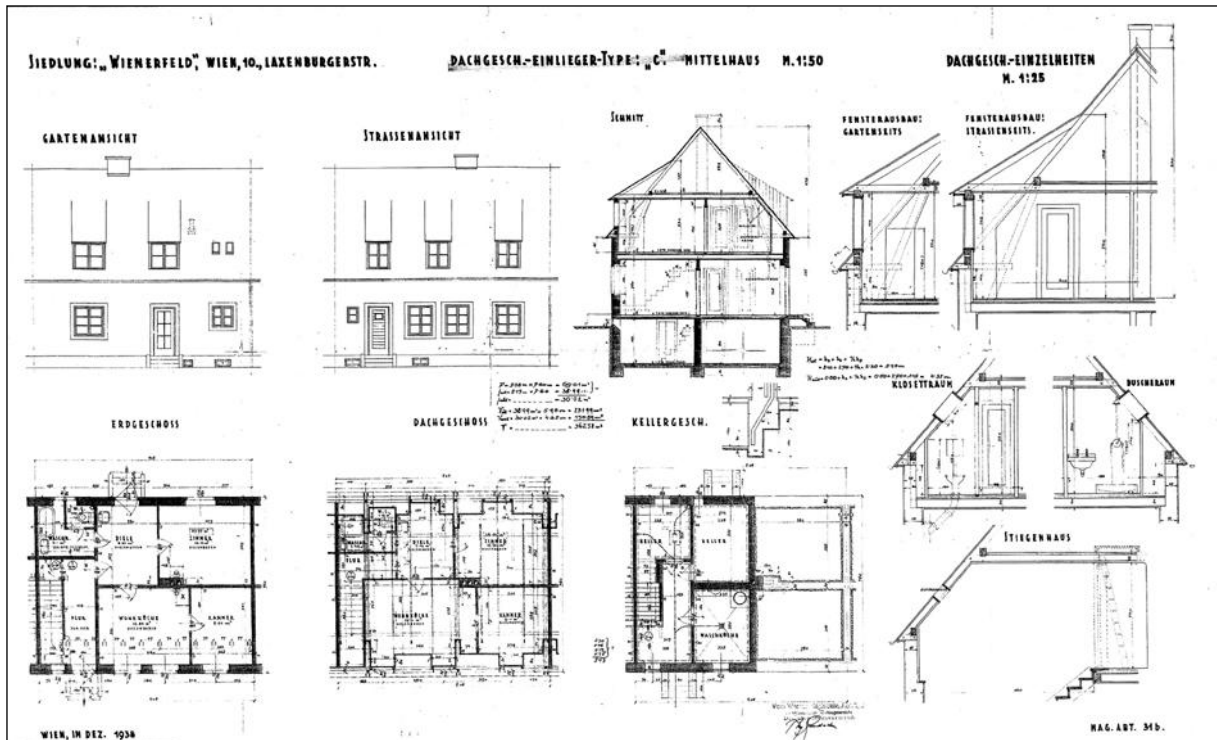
Type C: Zweifamilienhaus mit bäuerlichem Dachgeschoß – Einliegertyp
